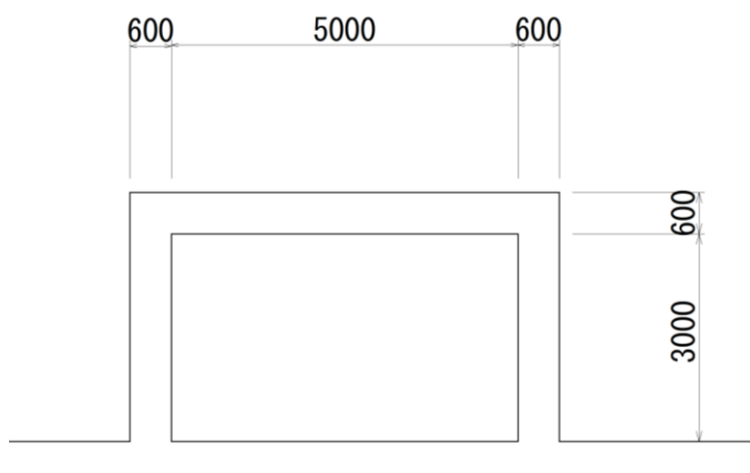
低圧原子炉代替注水ポンプ格納槽 平面図
